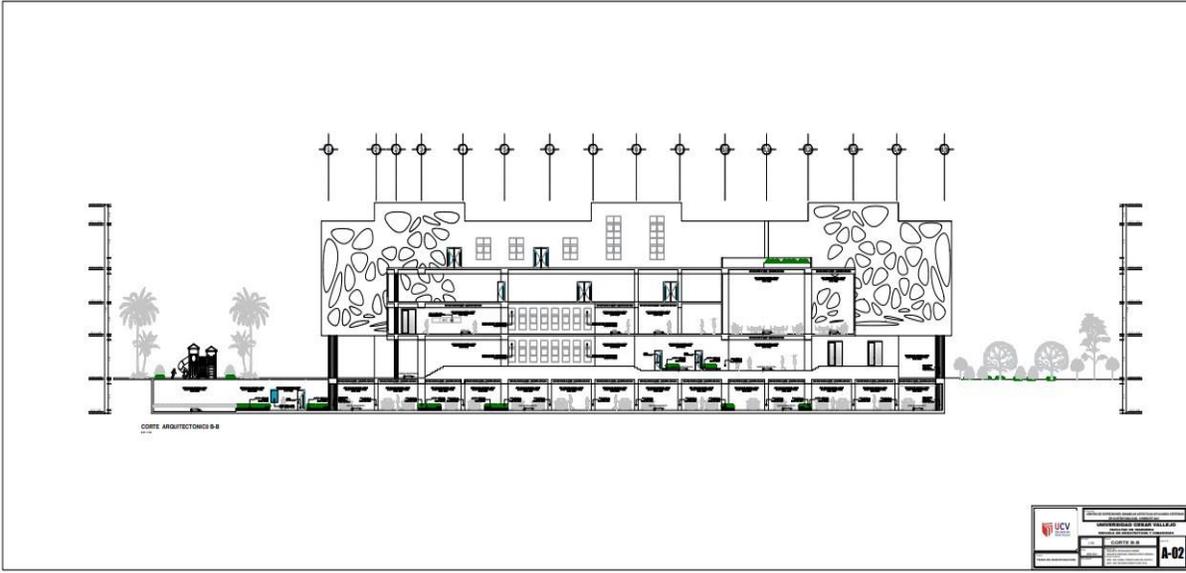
Plano Corte B-B Fuente: Elaboración Propia
